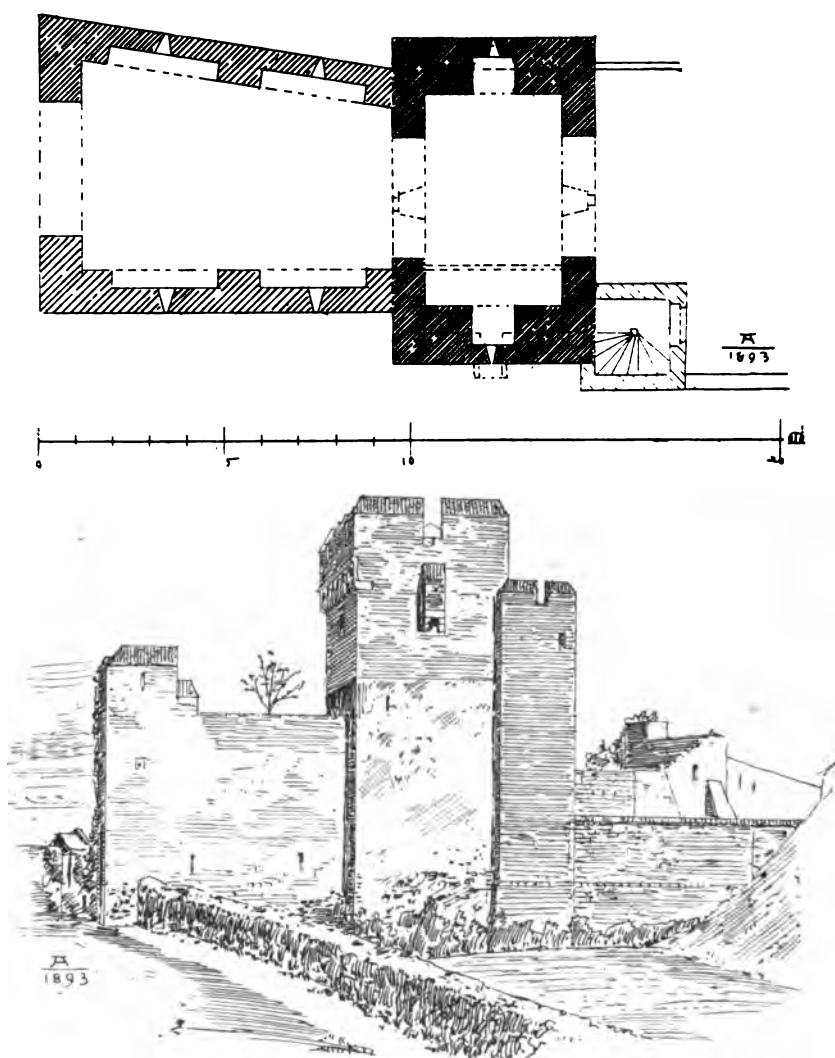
Zülpich. Grundriss und Ansicht des Kölnthores.
